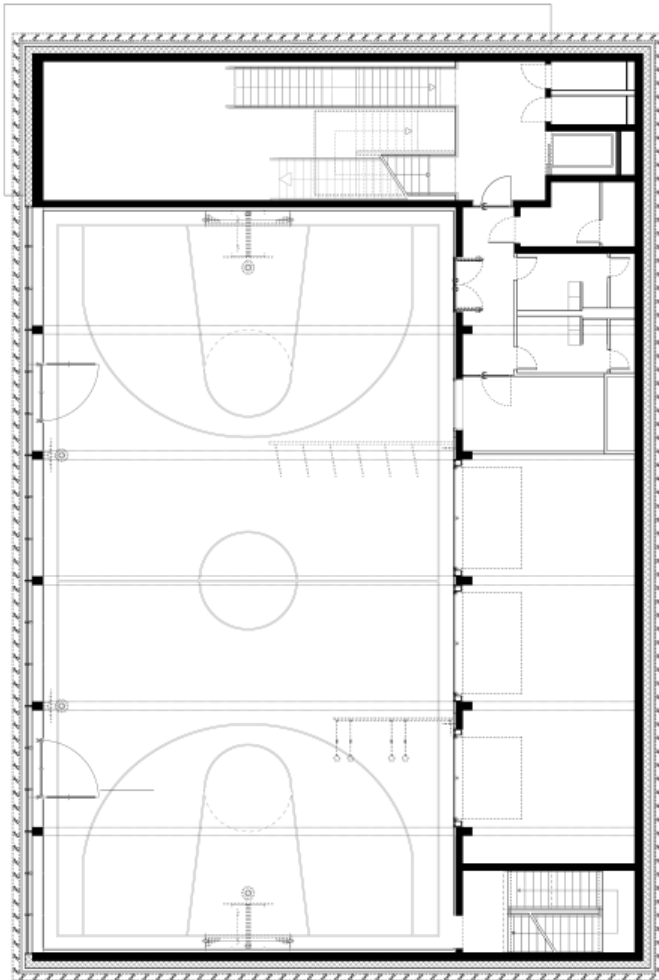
Grundriss 1. Obergeschoss: Regelgrundriss Hallengeschoß
